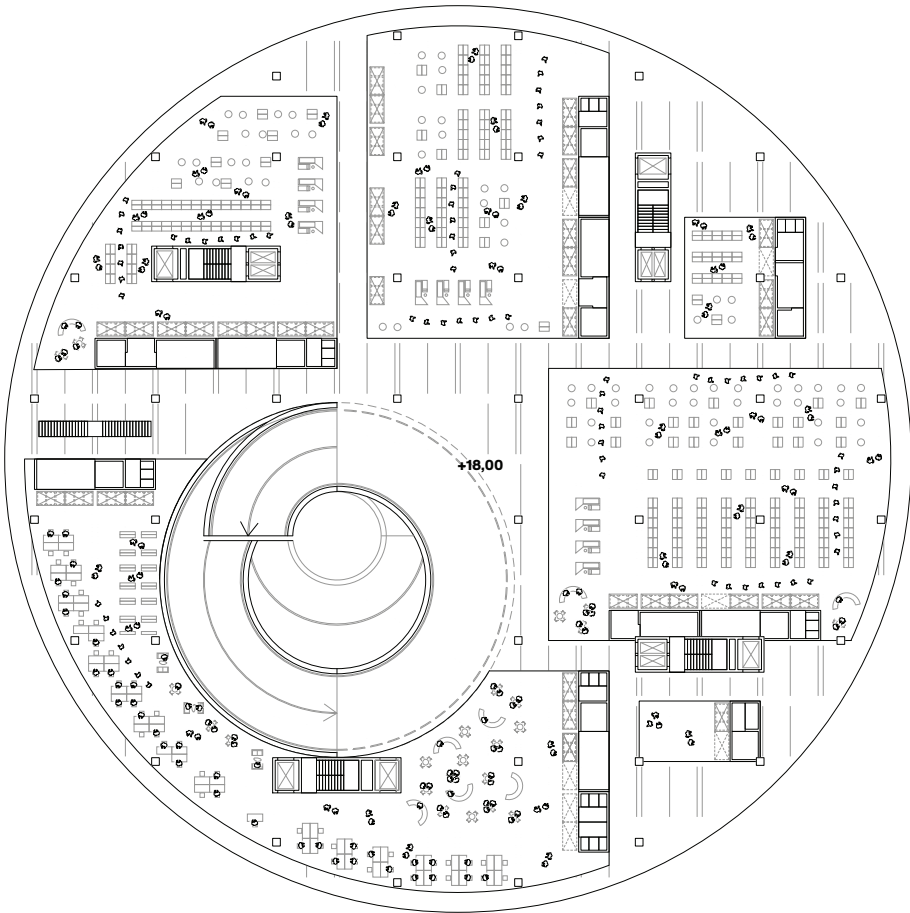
Grundriss . Obergeschoss (+06) . 1:750
